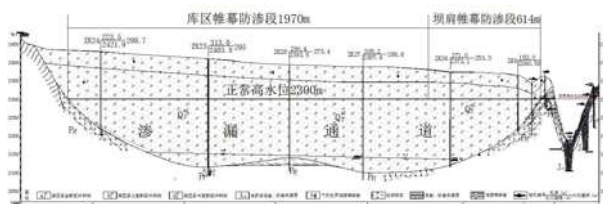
左岸防渗轴线工程地质剖面图 2.2 地下水流向
